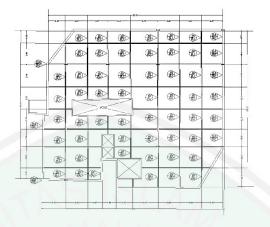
Denah rencana pembalokan lantai 1 berjenis beton
